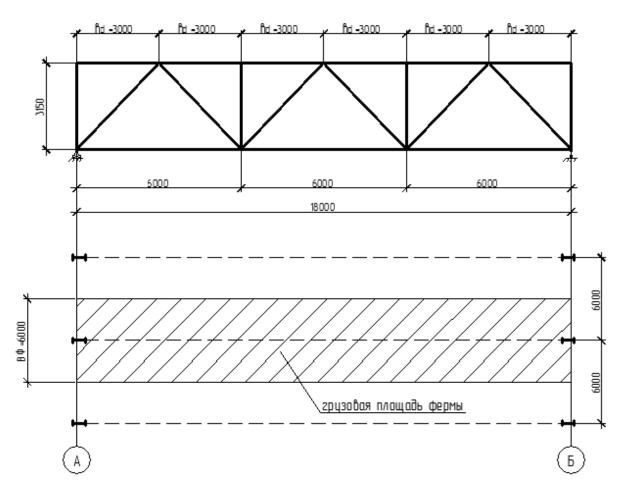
Расчетная схема и грузовая площадь фермы
